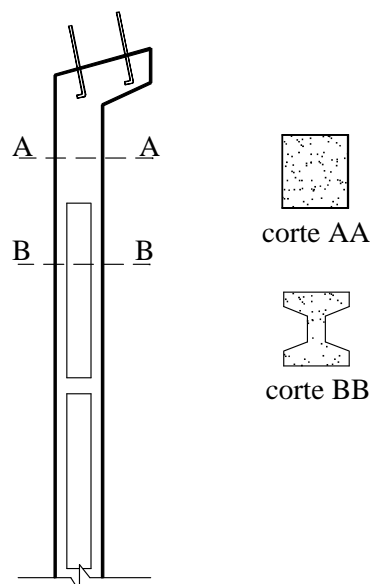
Forma longitudinal e seções transversais dos pilares.
